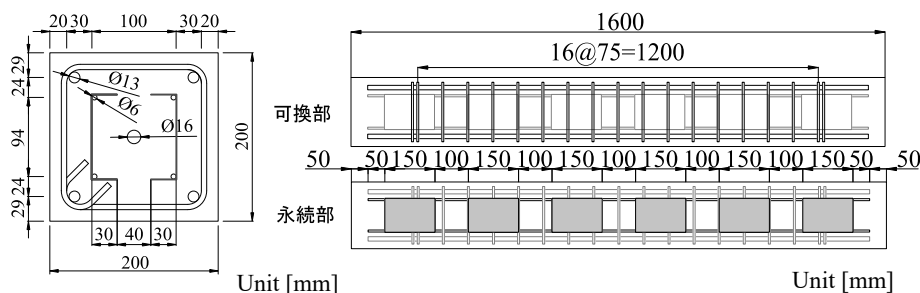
供試体の断面図及び側面図 [標準型のみ鋼板(色付部)無し]
